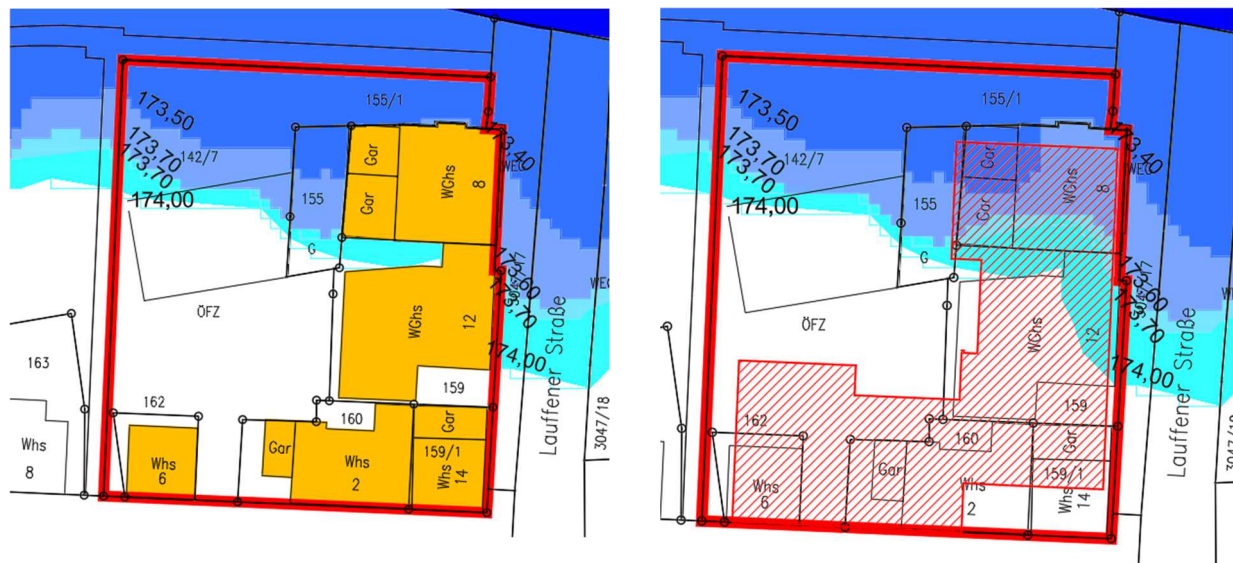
Darstellung Überflutungsflächen mit WSP-Lagen Bestand / Planung
